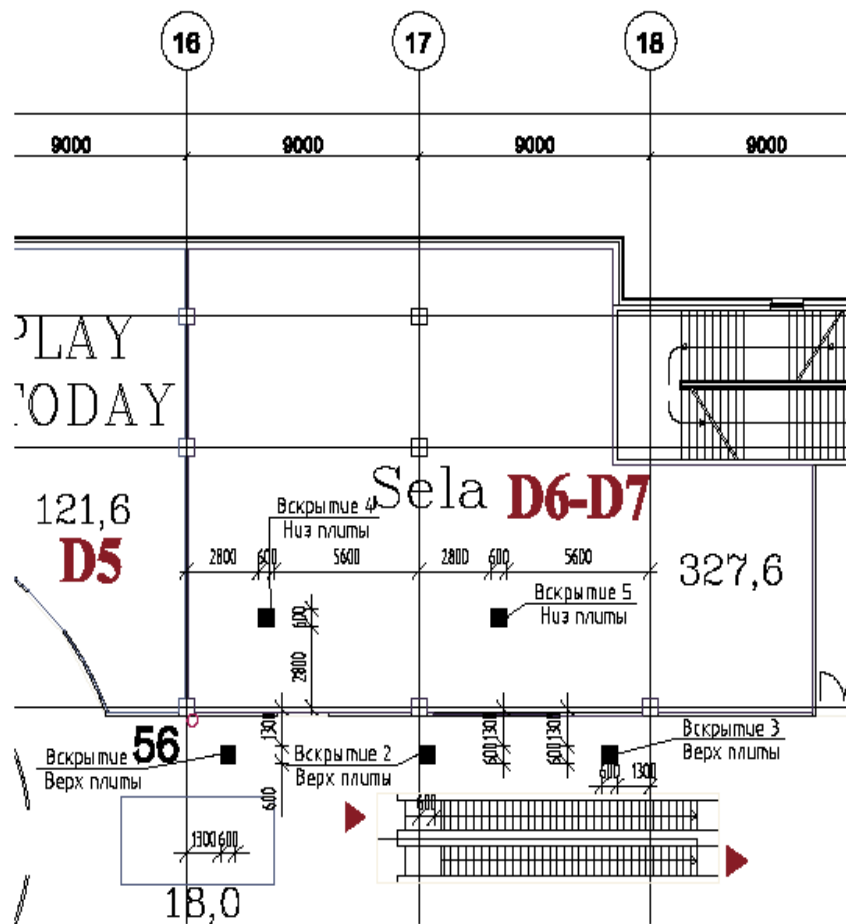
Места вскрытий арматуры в плите на отм. +17.100 в осях 16-19/Ф-Ц
